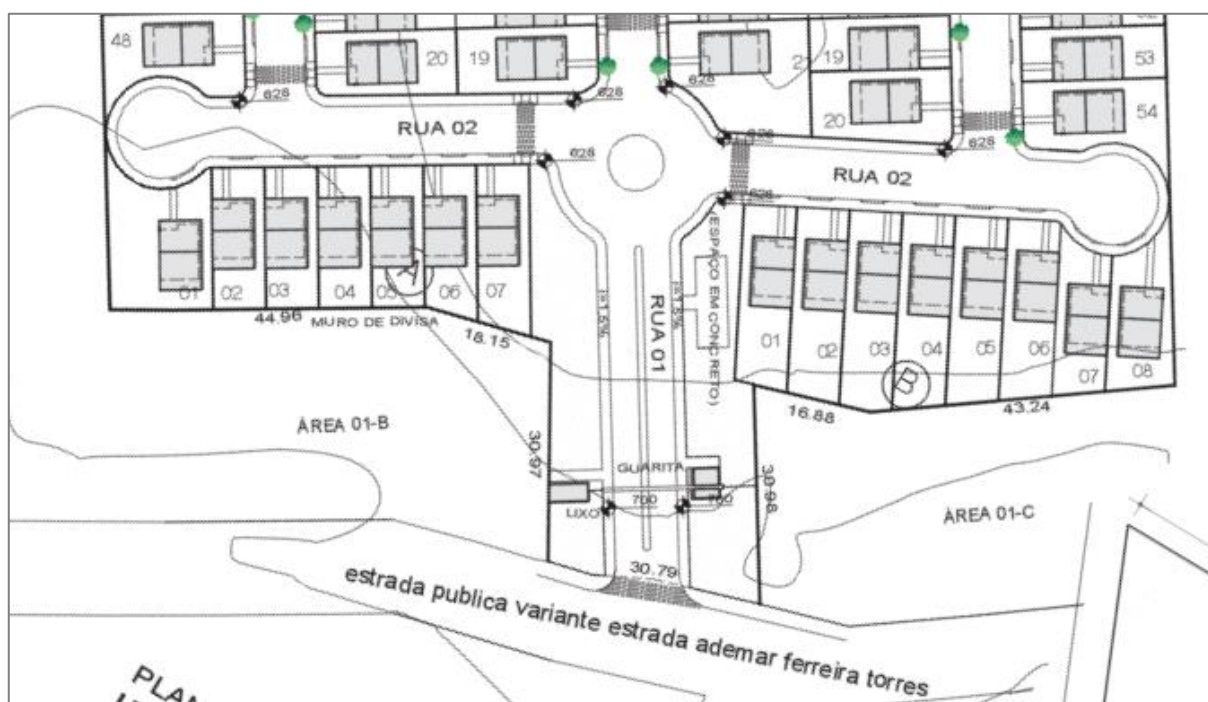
Recorte planta baixa evidenciando a portaria (sem escala).
